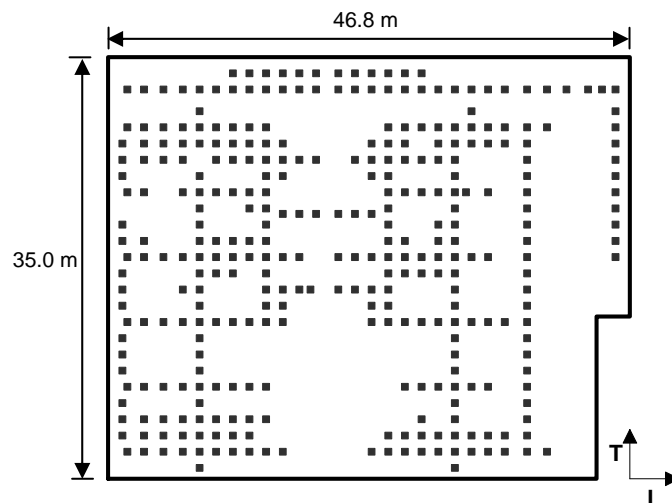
Planta de cimentación y distribución de los pilotes en el edificio
